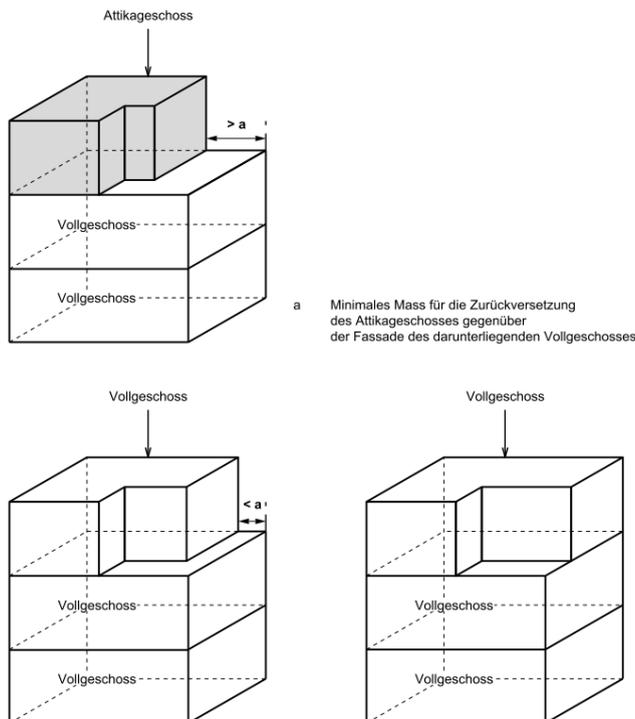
Figur 6.4 Attikageschoss, IVHB
